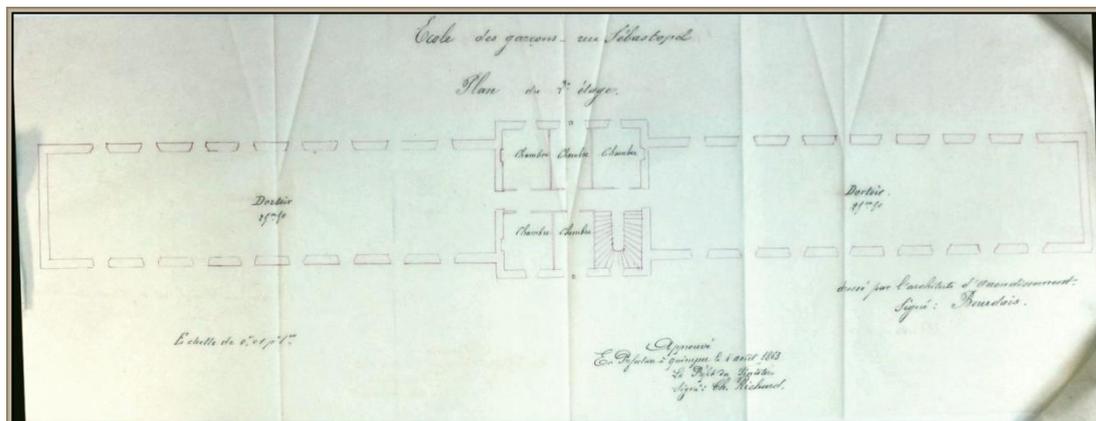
a, b, c et d - J. Bourdais, plans du projet de 1863 -
